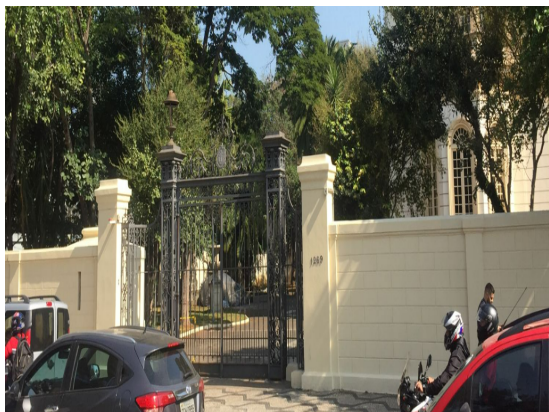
Pintura do muro frontal da Avenida Rio Branco
